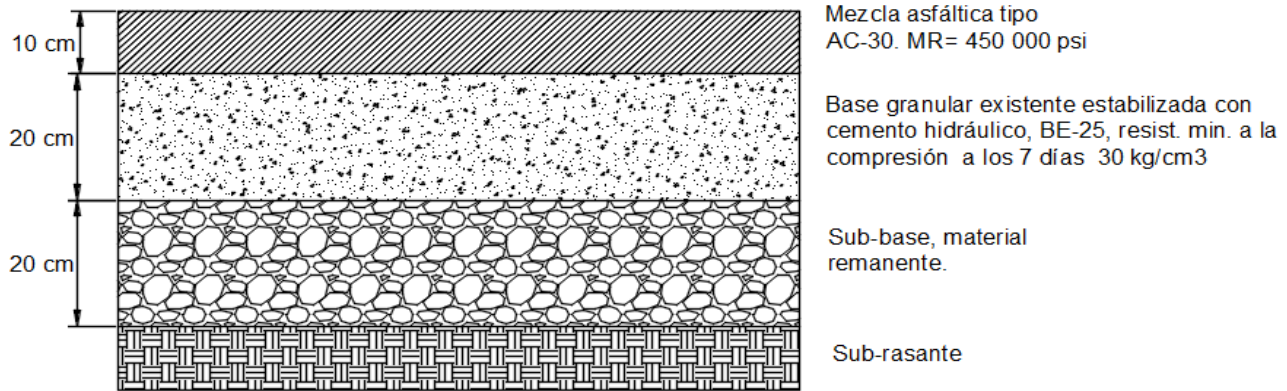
Perfil de la estructura de pavimento propuesta para el TH=36, P#5-P#6.
